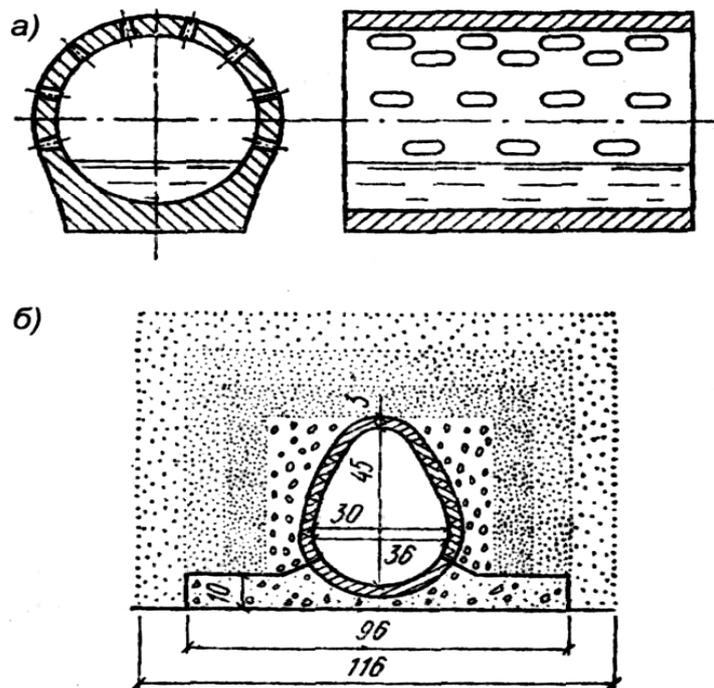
Перфорированные бетонные трубы круглого (а) и овоидального (б) сечений
